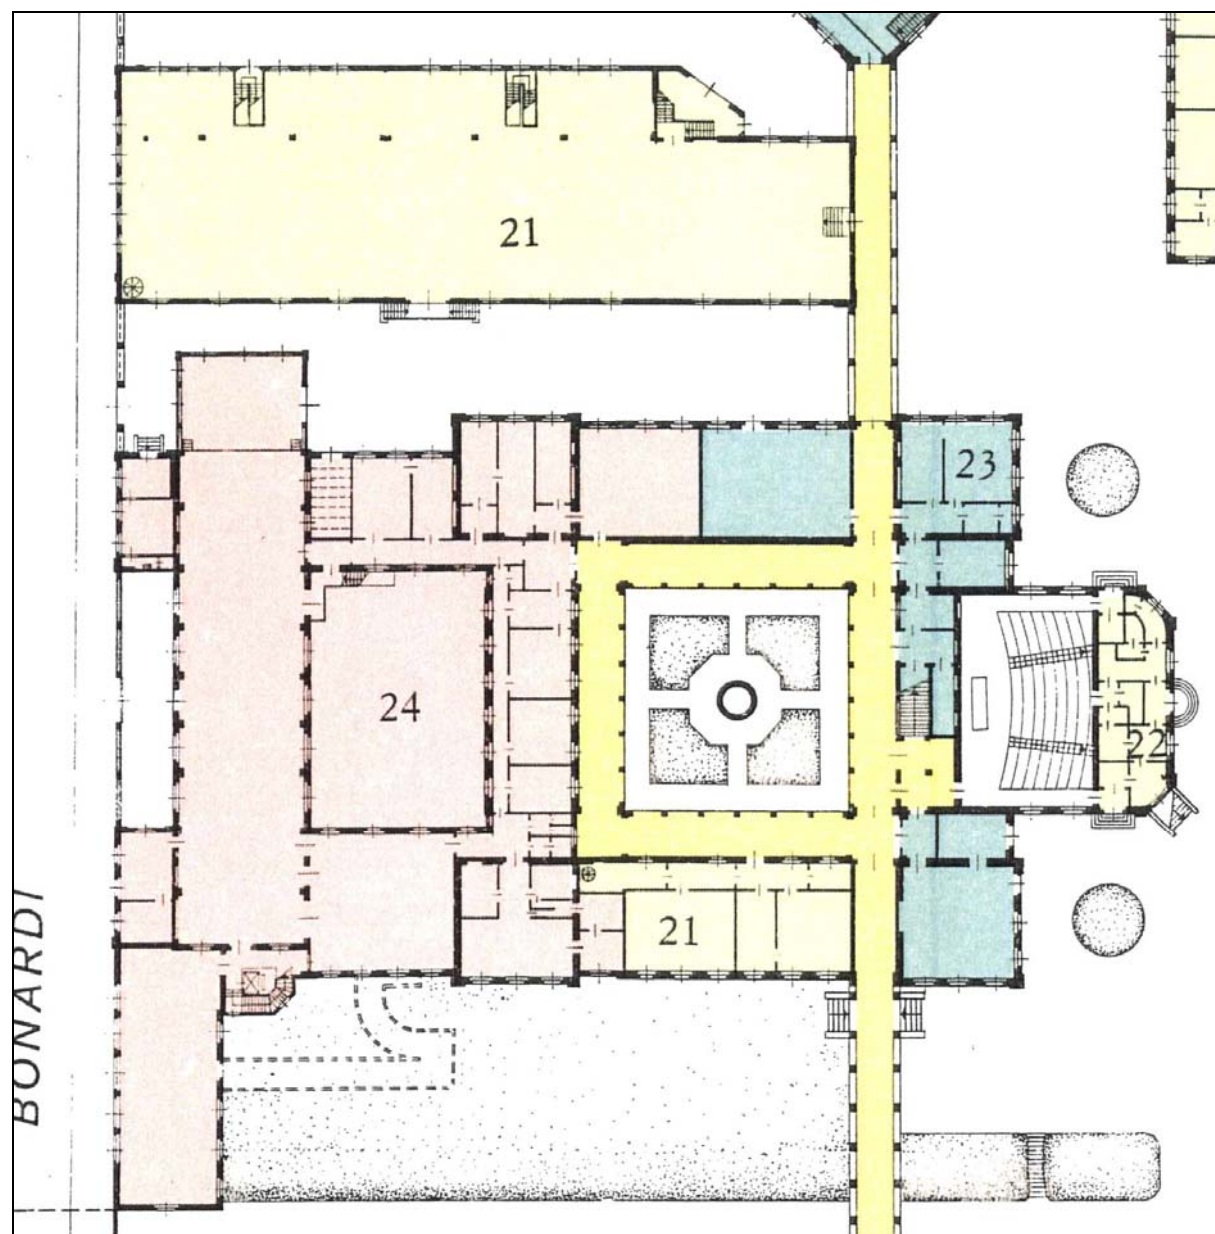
Planimetria del Piano Rialzato ED 4 e ED 10 (1963)
